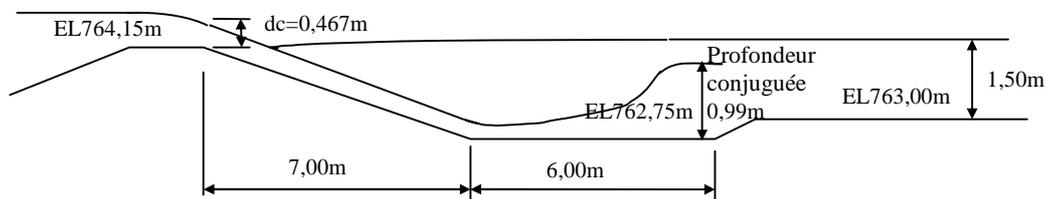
Caractéristiques hydrauliques du dessableur et de la section d'accès au canal principal P1
